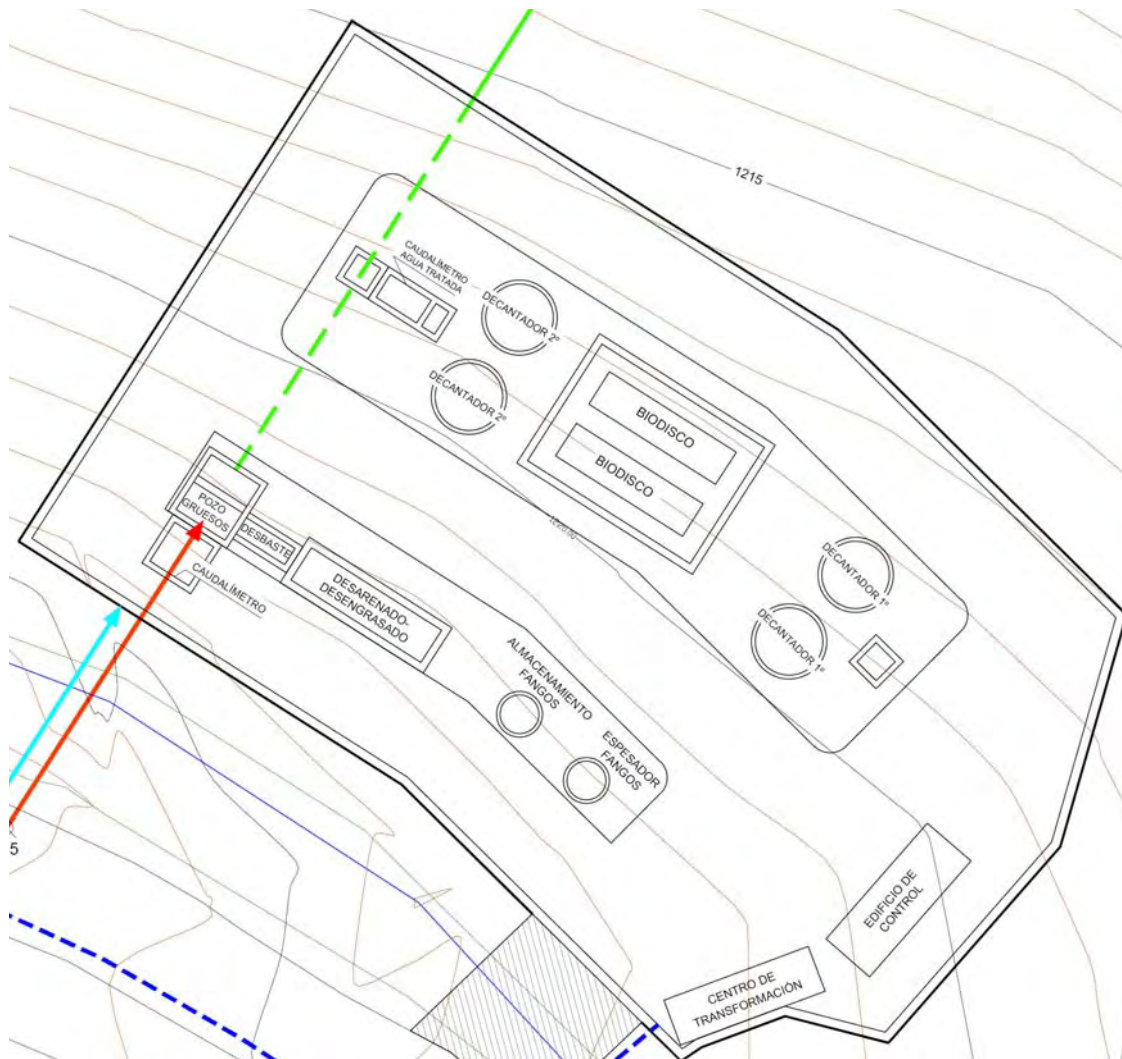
Detalle EDAR. (Ver plano 04 EDAR. Planta)
